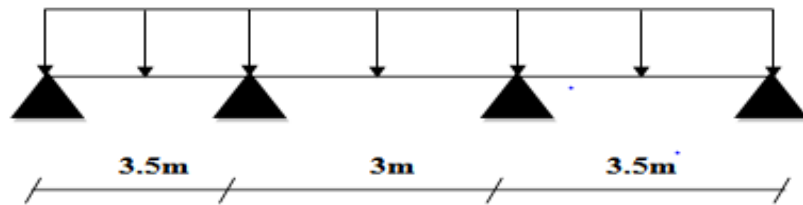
schéma statique de la poutre reposant sur quatre appuis.
